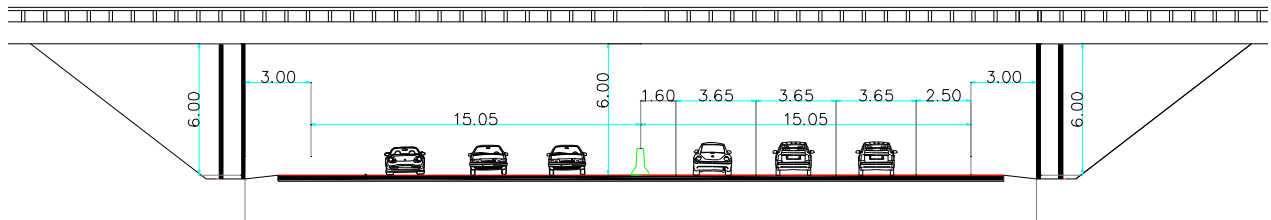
A. 204-34. ancho mínimo de autopista bajo estructura
